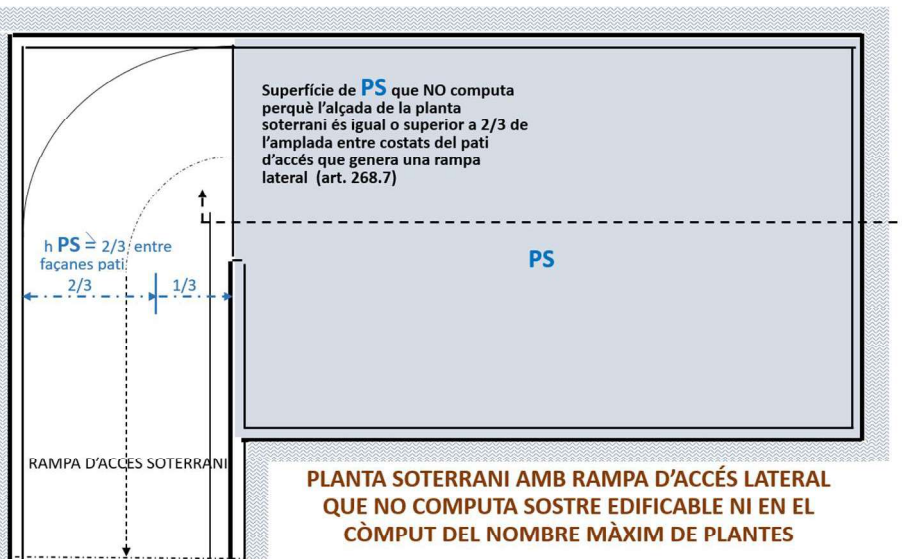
Art. 250.5, 251.2 i 268.7. Condició de planta baixa i planta soterrani amb accés lateral o parcial al soterrani, als efectes del còmput del nombre màxim de plantes i del sostre edificable.
